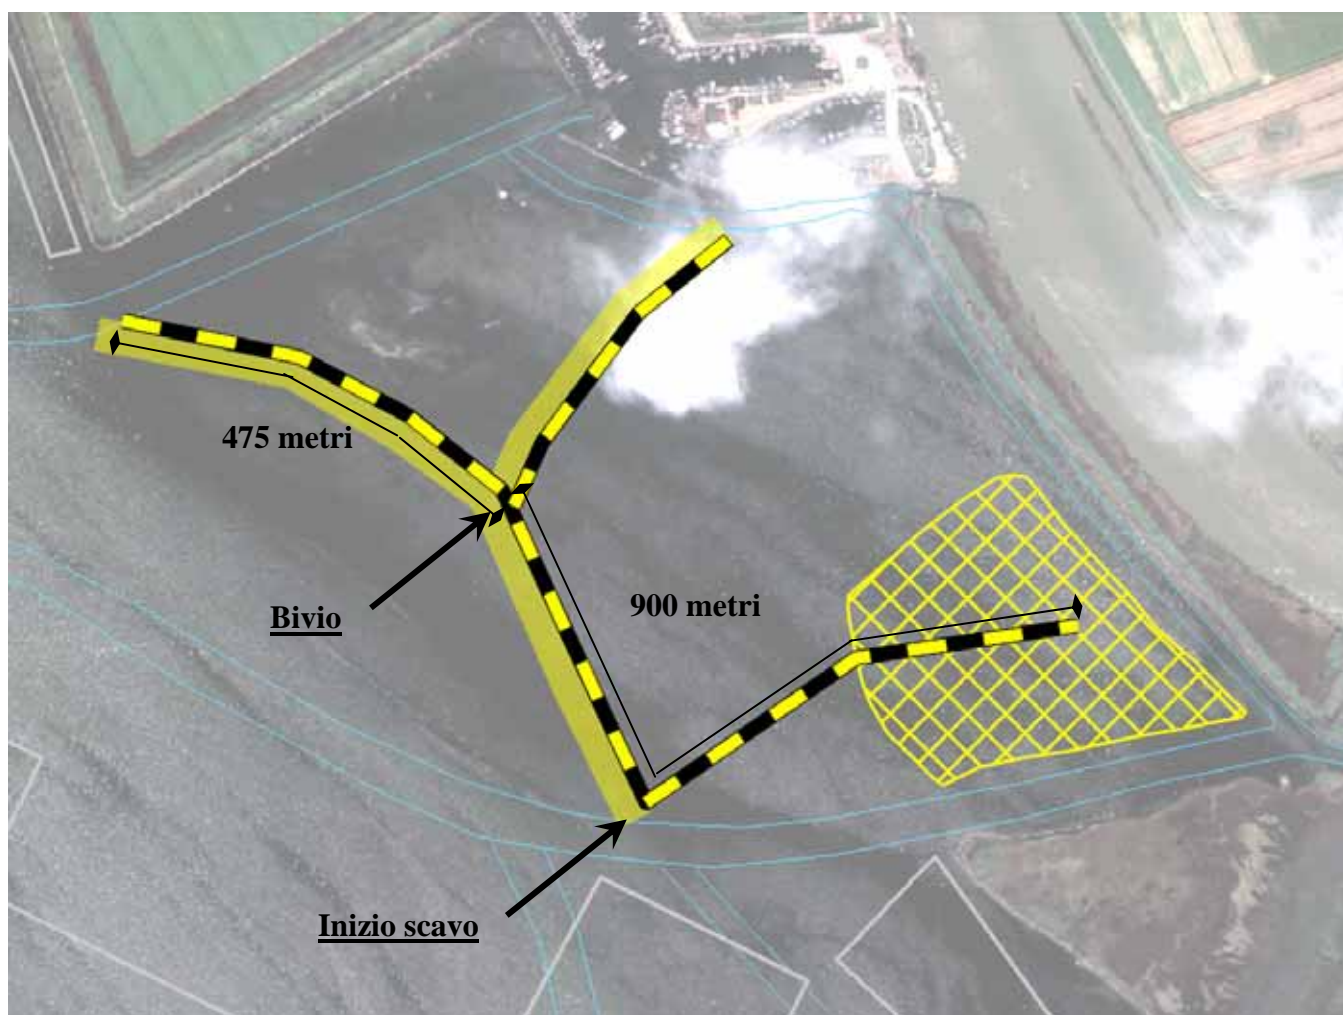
Disposizione tubazione per lo scavo del canale 1
